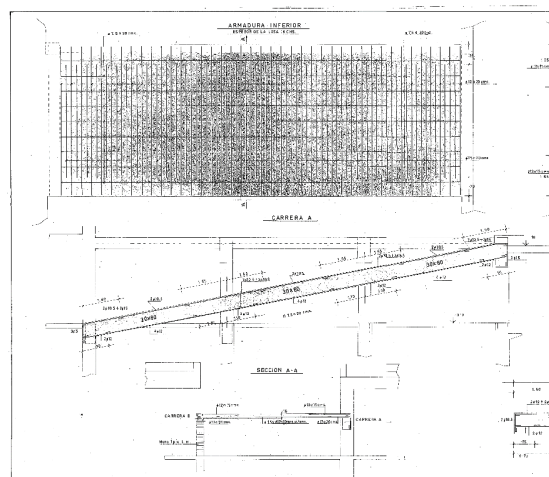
Detalle de vigas laterales de rampa de acceso
